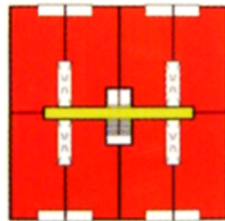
8 viviendas por planta , 4 expuestas a la calle y 4 de patio.
